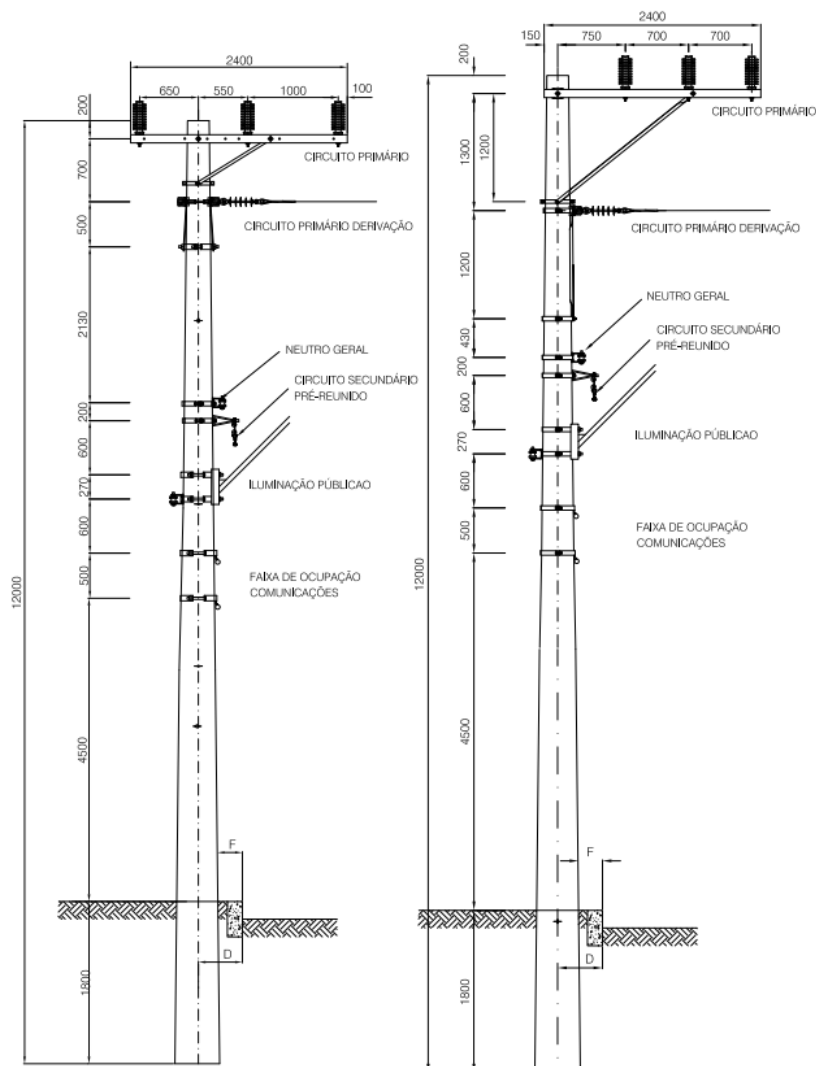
Estruturas típicas de uma Rede de Distribuição em Média Tensão Fonte: [13]
